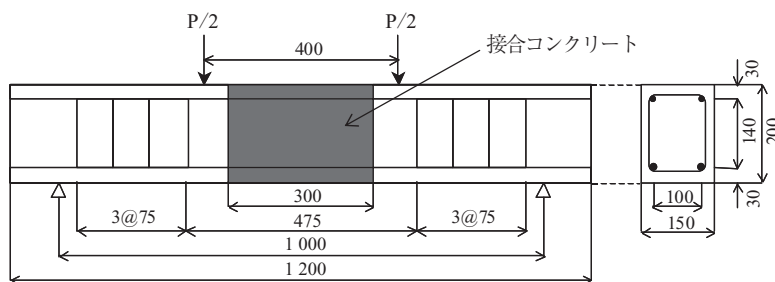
接合コンクリートを用いた梁供試体の形状寸法 (mm)
